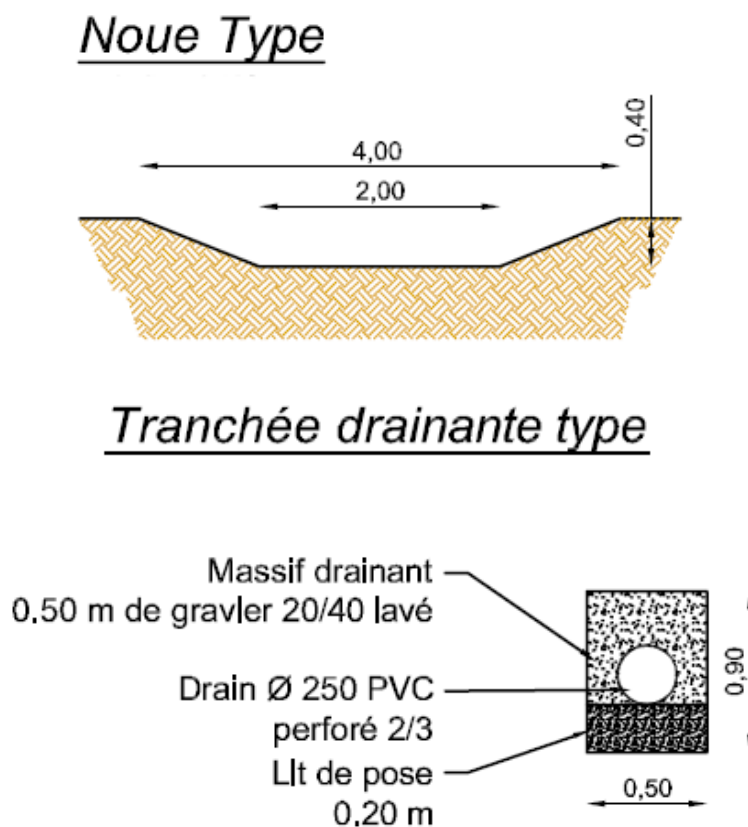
Principe des ouvrages de collecte longitudinaux des eaux pluviales
